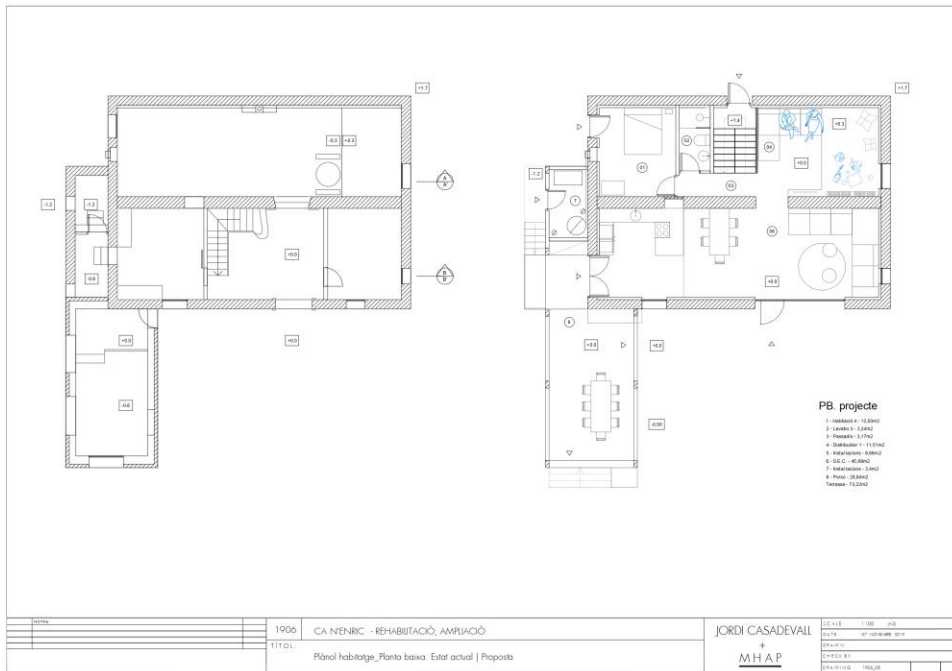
Planimetria de la planta baixa. A l'esquerra es pot veure l'estat actual i a la dreta la proposta arquitectònica.
